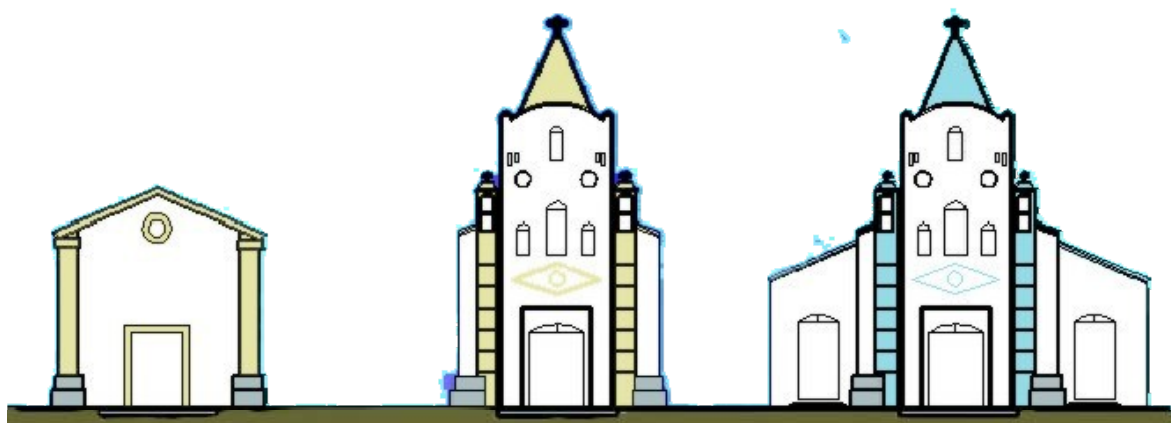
Fachada original – Fachada após 1953 – Fachada atual
